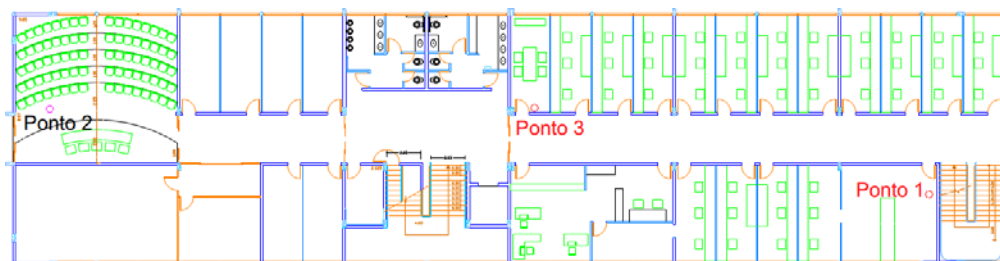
Localização dos Xbees na planta do Segundo Pavimento do Bloco C67, da UEM, sem escala.
